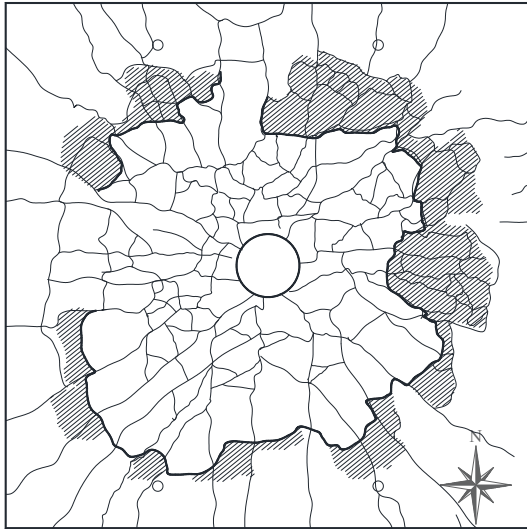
Mapa de fissuração da laje SS1
